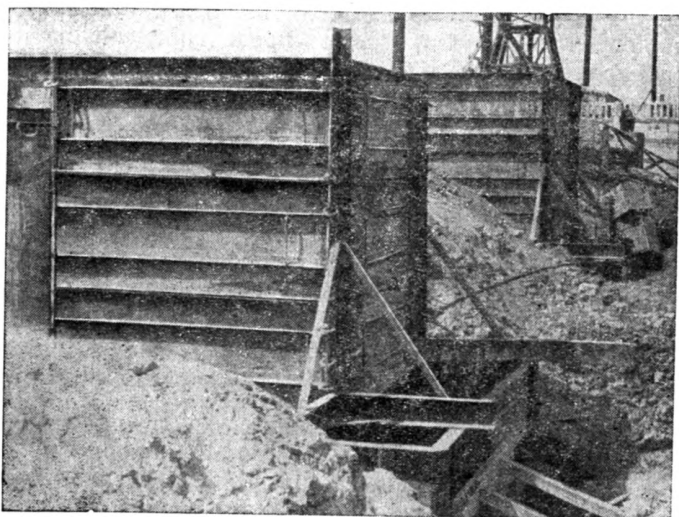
Общий вид стальной опалубки ступенчатого фундамента (опалубка Минмонтажспецстроя)
